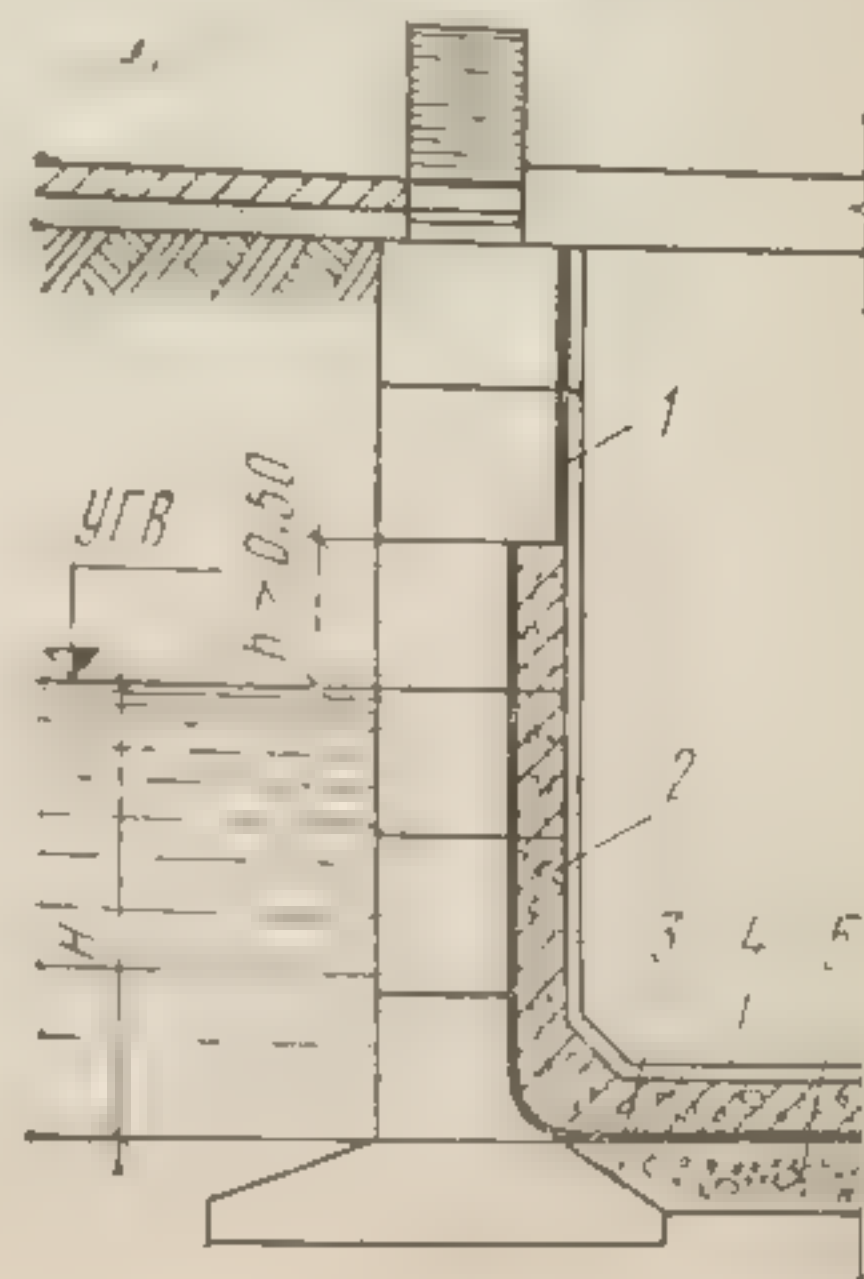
Гидроизоляция подвала при больших напорах грунтовых вод, устраиваемая по внутренней поверхности стены:
